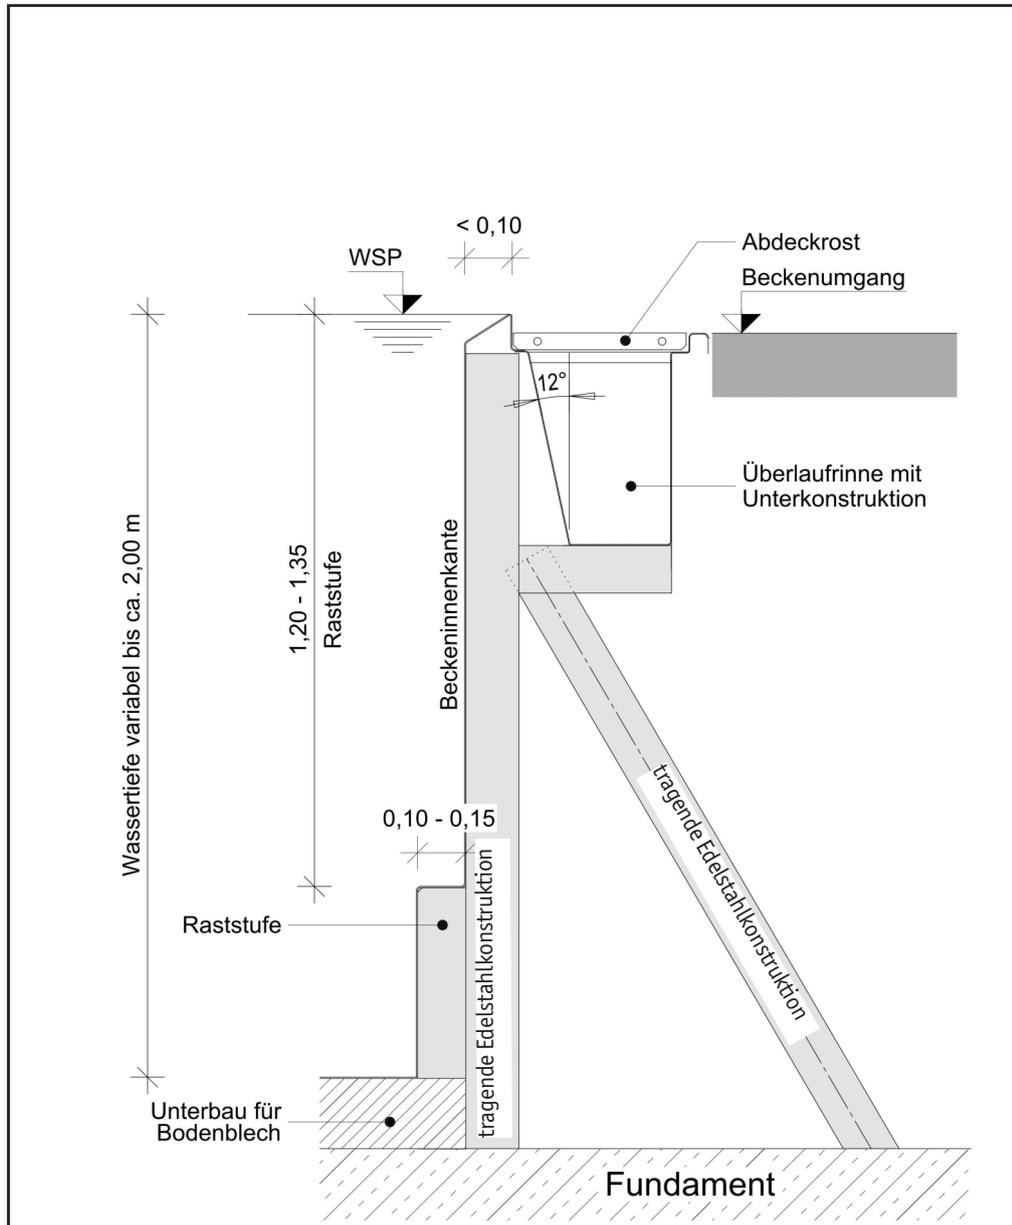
Beckenwand mit tragender Edelstahlkonstruktion, mit Beckenraststufe
